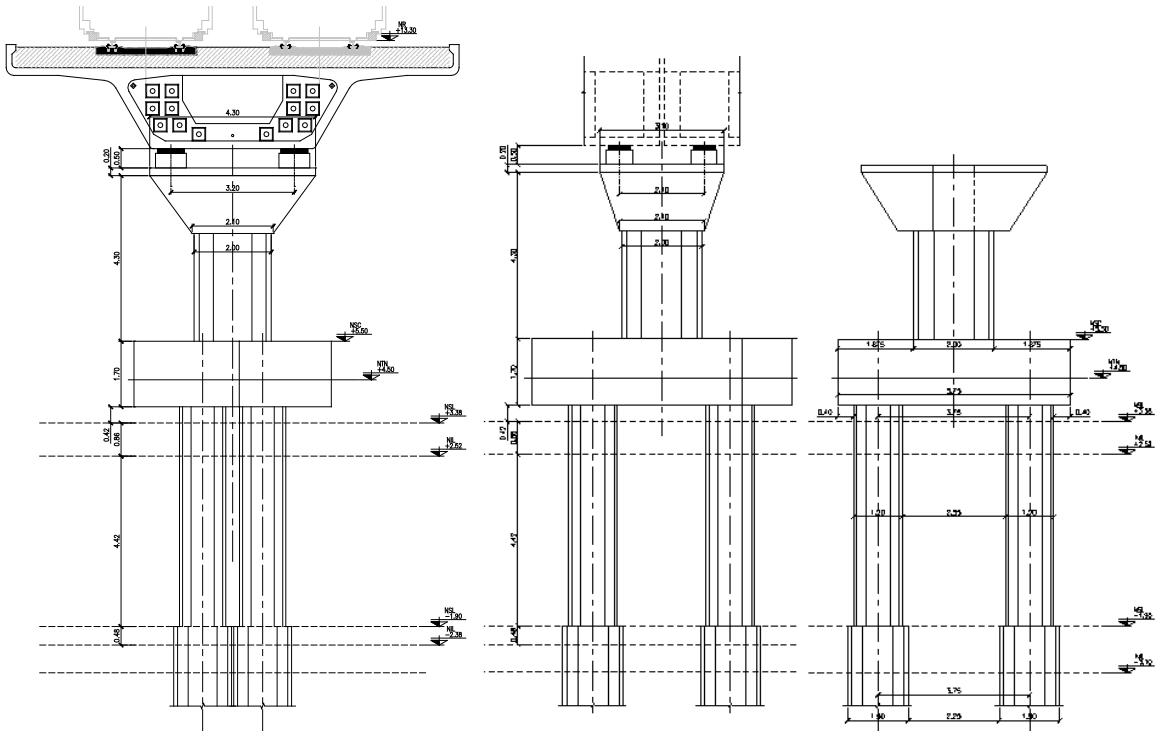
Pila central sobre el eje del túnel de la Av. del Libertador.
